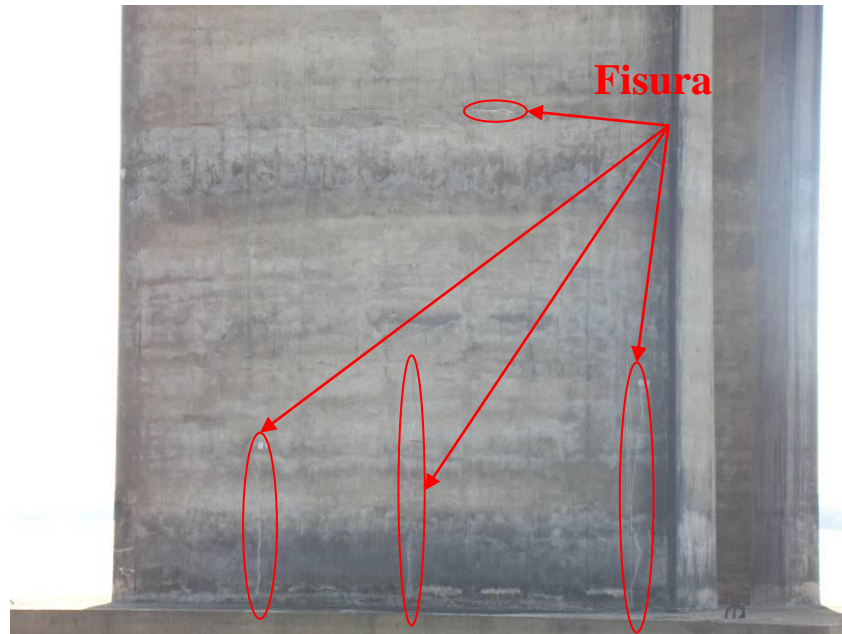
Vista de la Pila 5 perteneciente al Viaducto Uruguayo. Se encuentran indicadas fisuras verticales.
